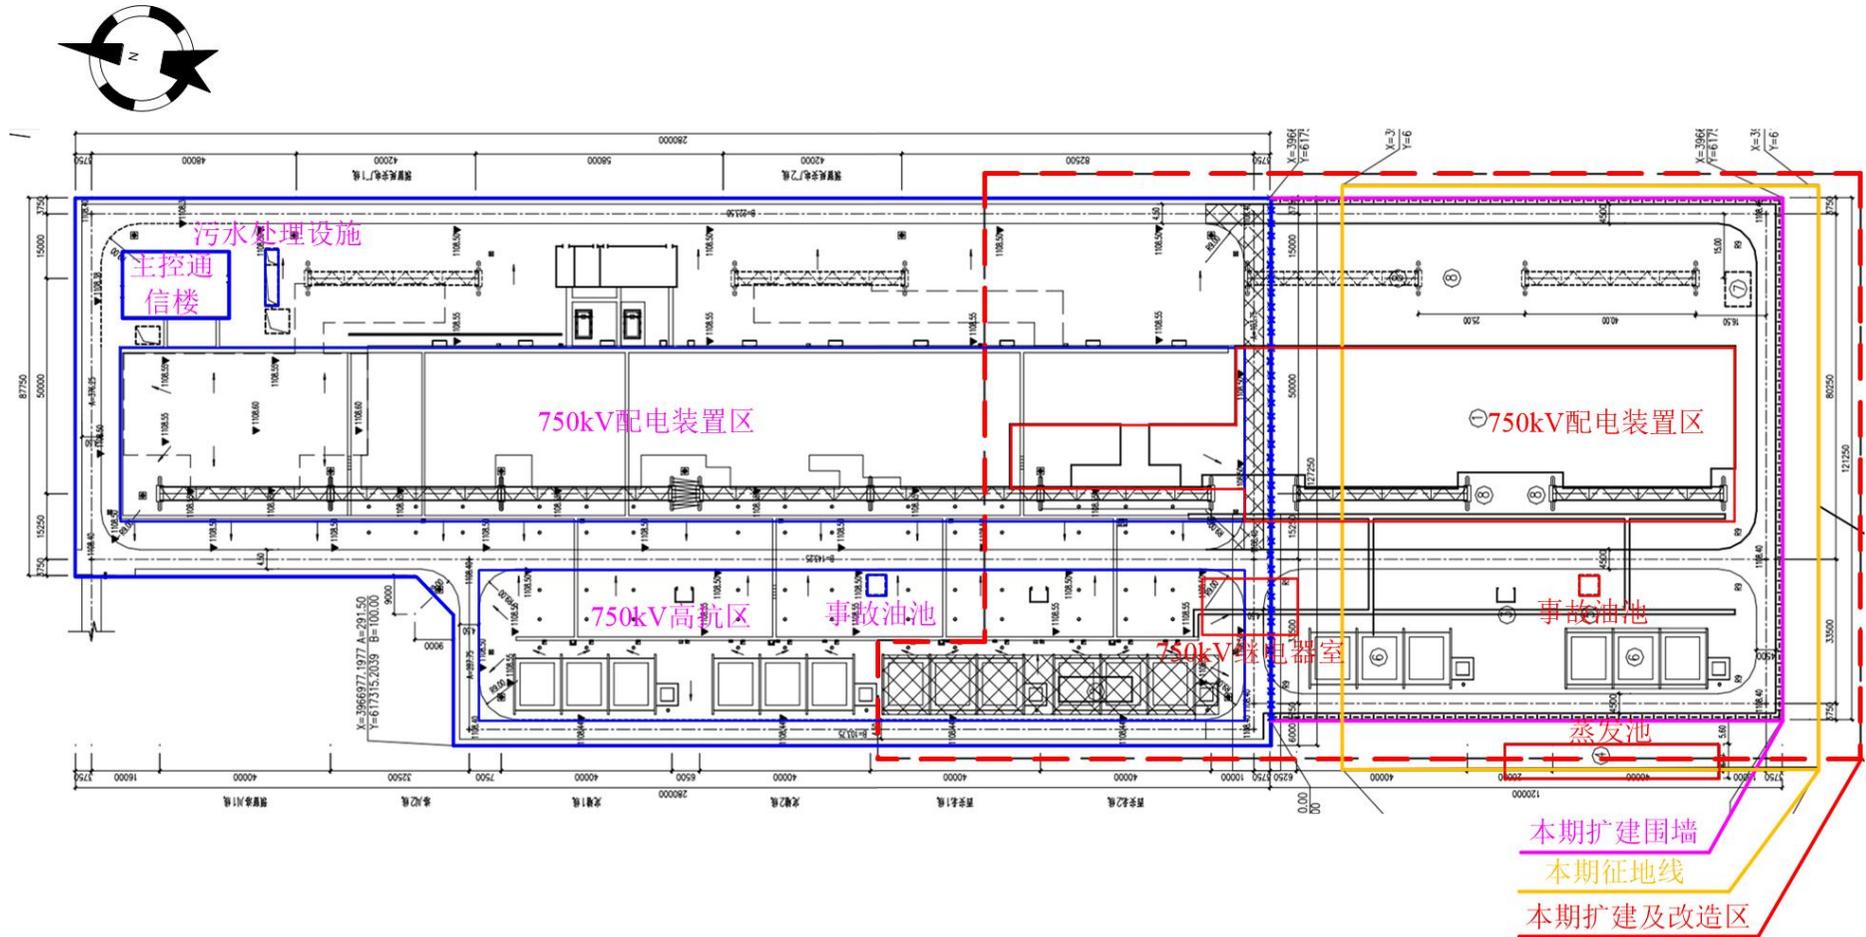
秦道 750kV 开关站土建总平面布置示意图 (扩建后)
